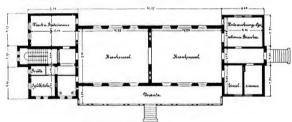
Gebäude 5 und 6; Grundriss.
